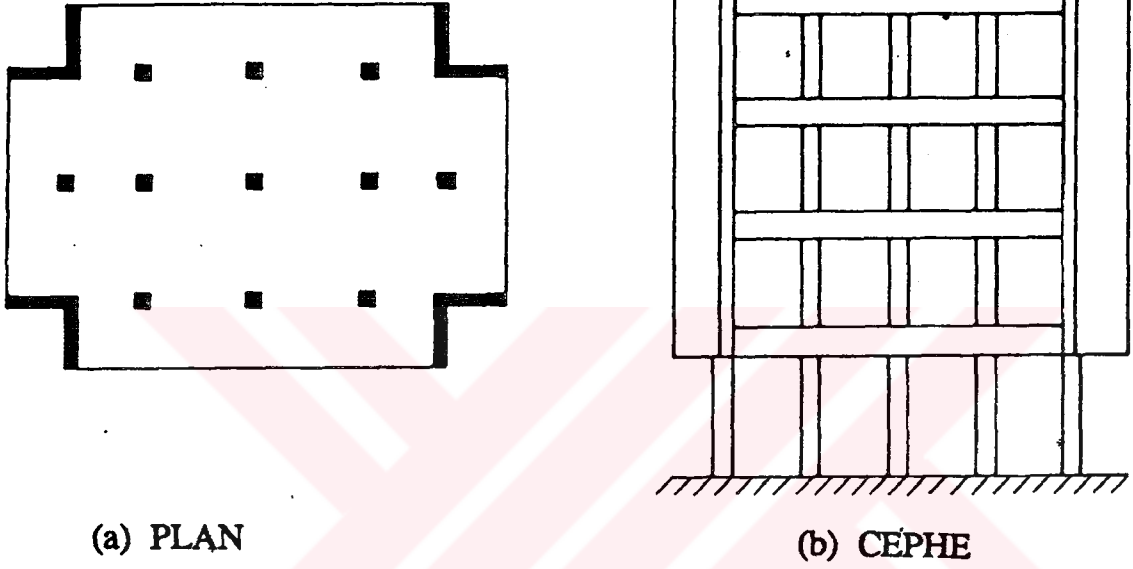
Kuvvetli Kiriş Zayıf Kolon
